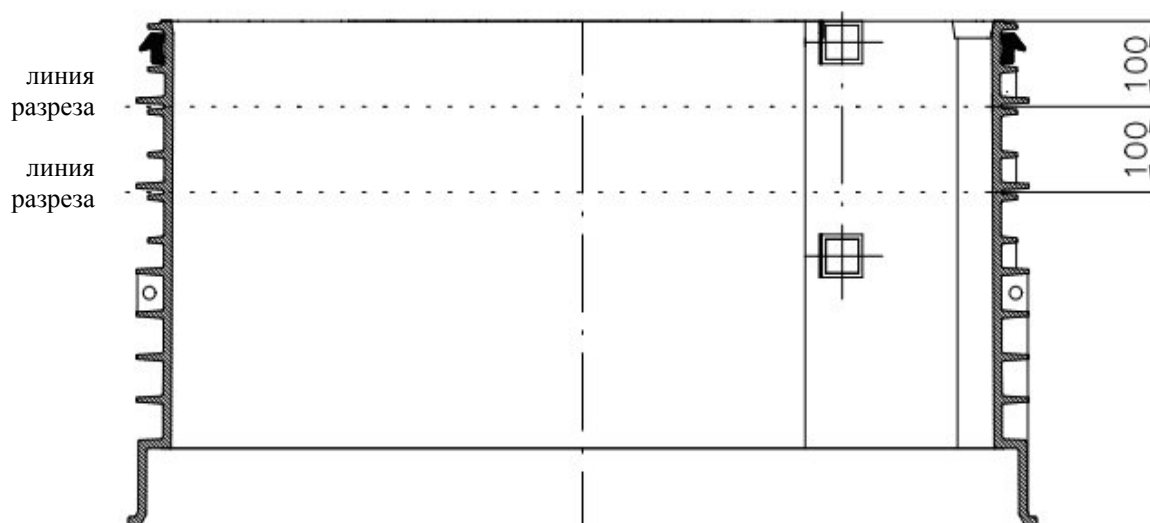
Кольцо корпуса колодцев PRO 800, 1000
